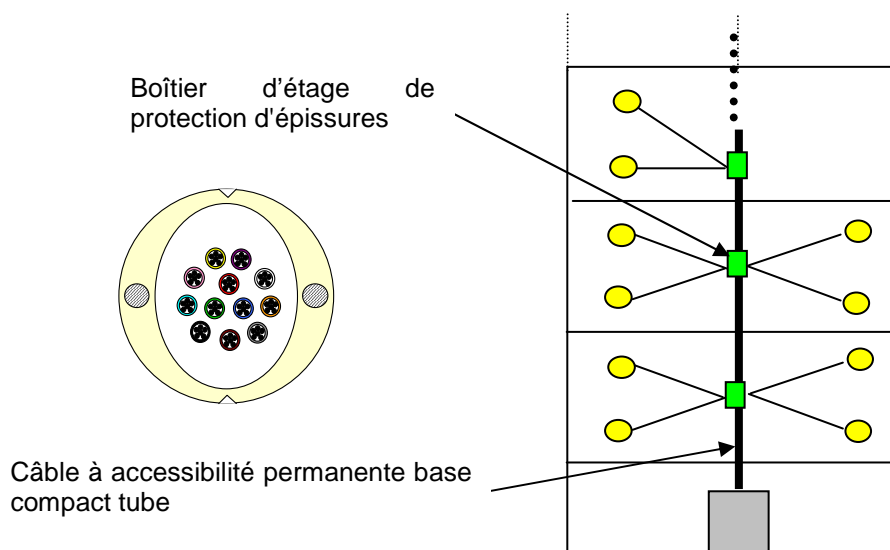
système de câblage d'immeuble : câble à accessibilité permanente à tubes multi fibres
